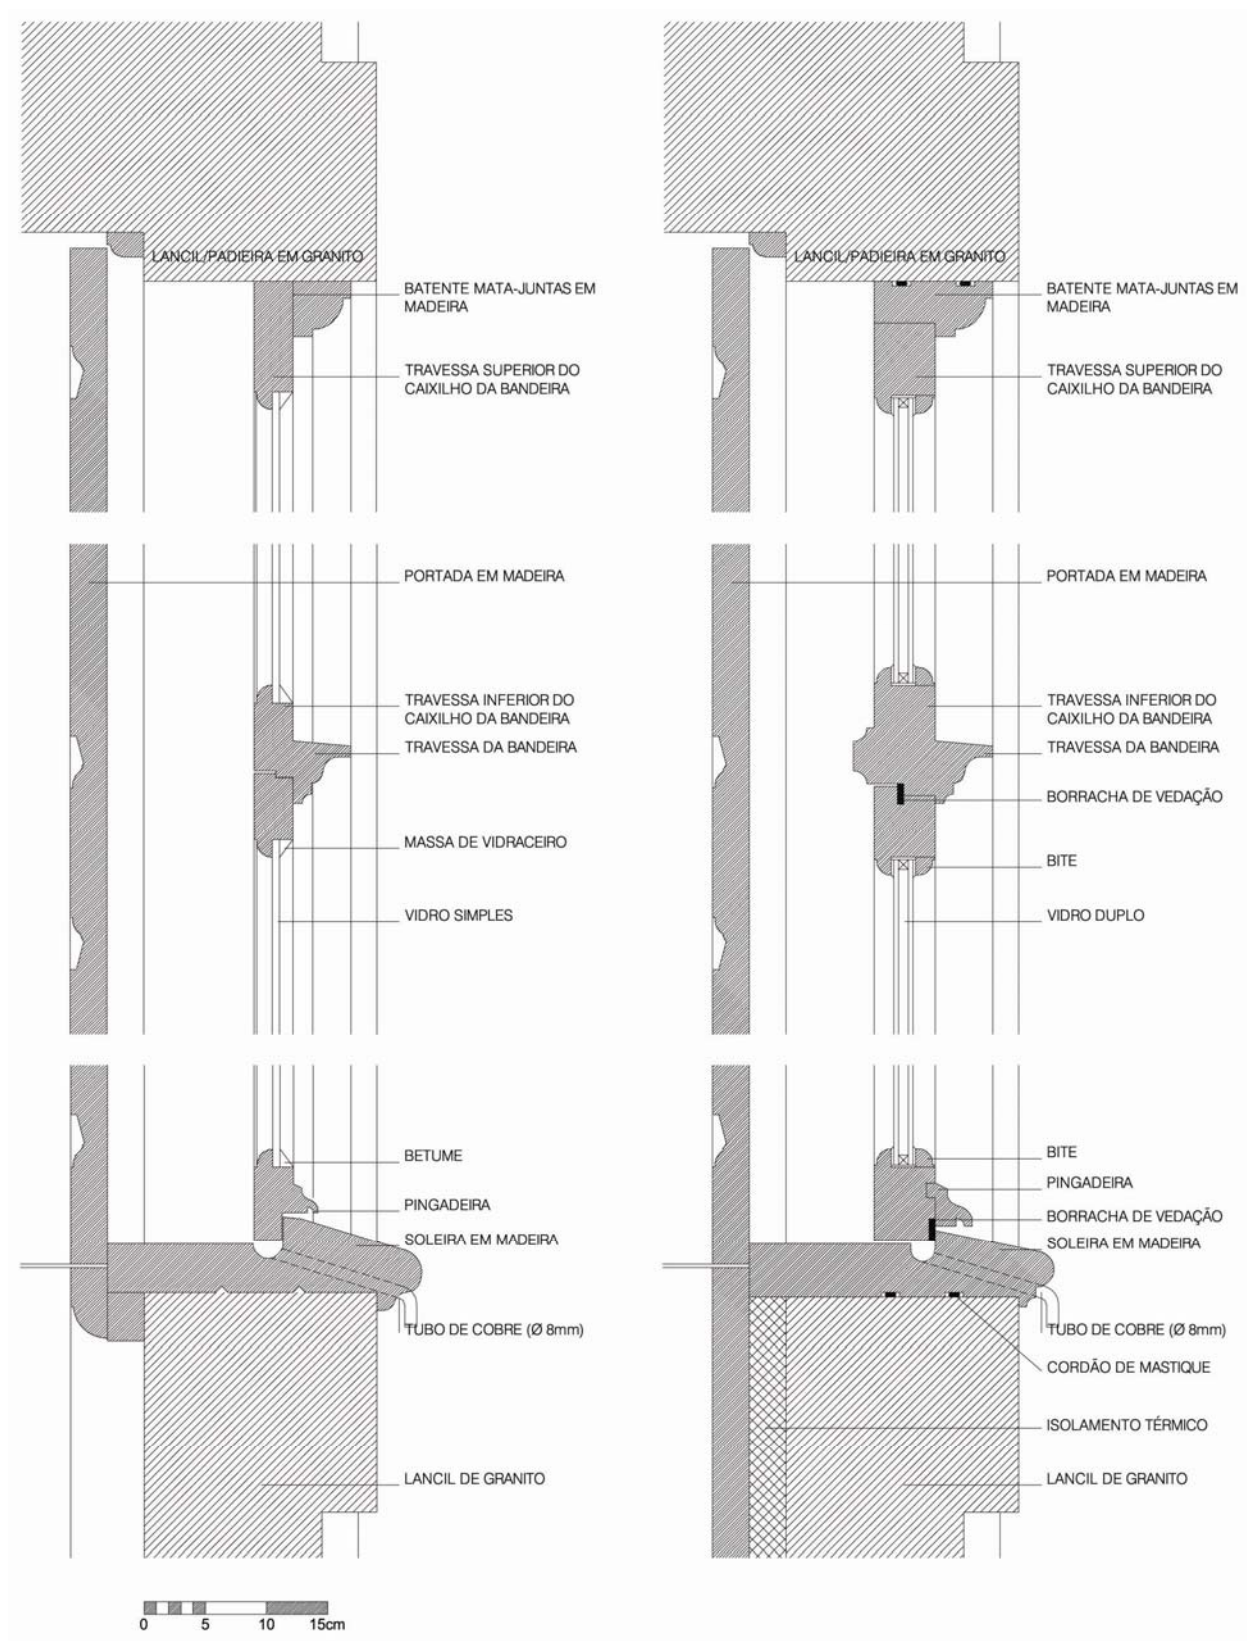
Substituição da caixilharia existente por uma nova caixilharia (re) interpretando o desenho original - pormenores dos cortes verticais da caixilharia existente e da caixilharia proposta.
